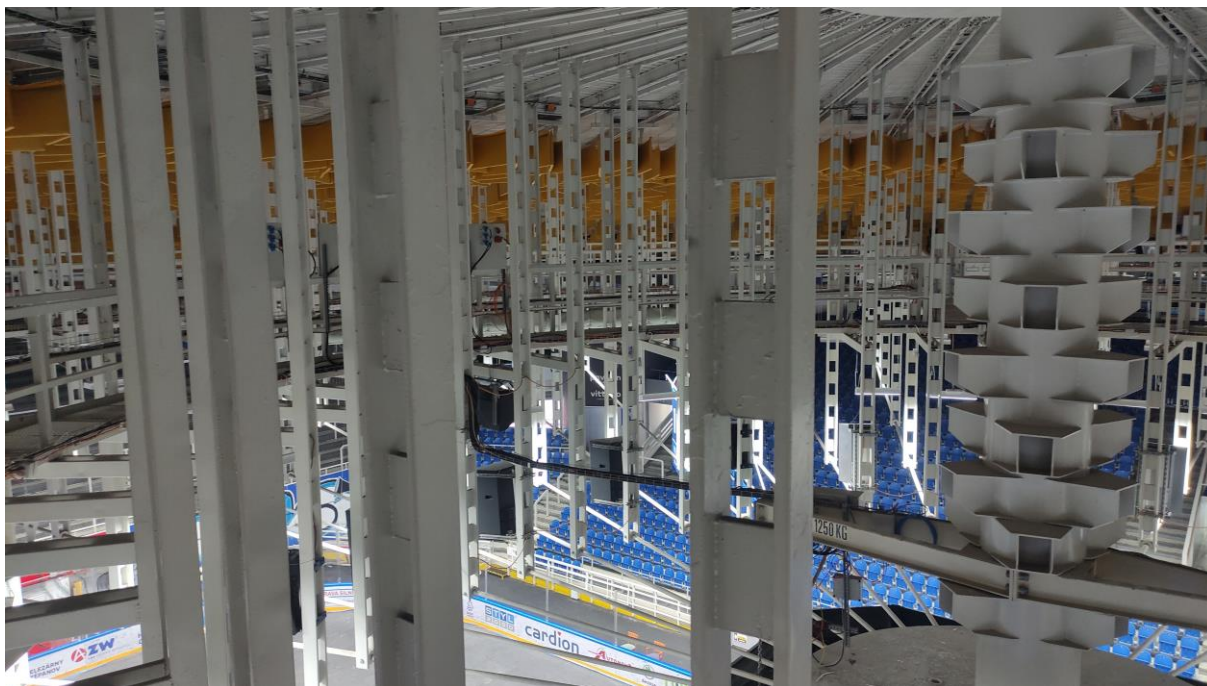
Detailní pohled na rozpínací vřeteno a svislice mezi horními a dolními lany
